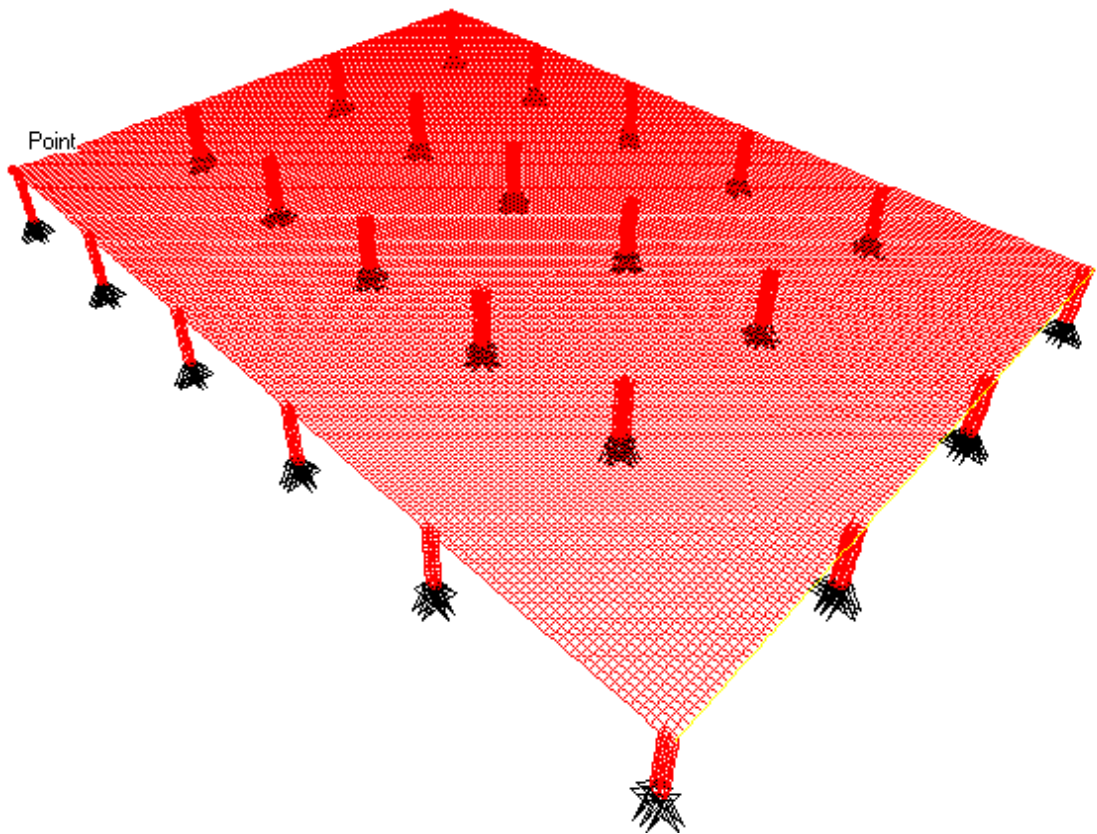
Laje Lisa sobre apoios sólidos – Vista 3D
